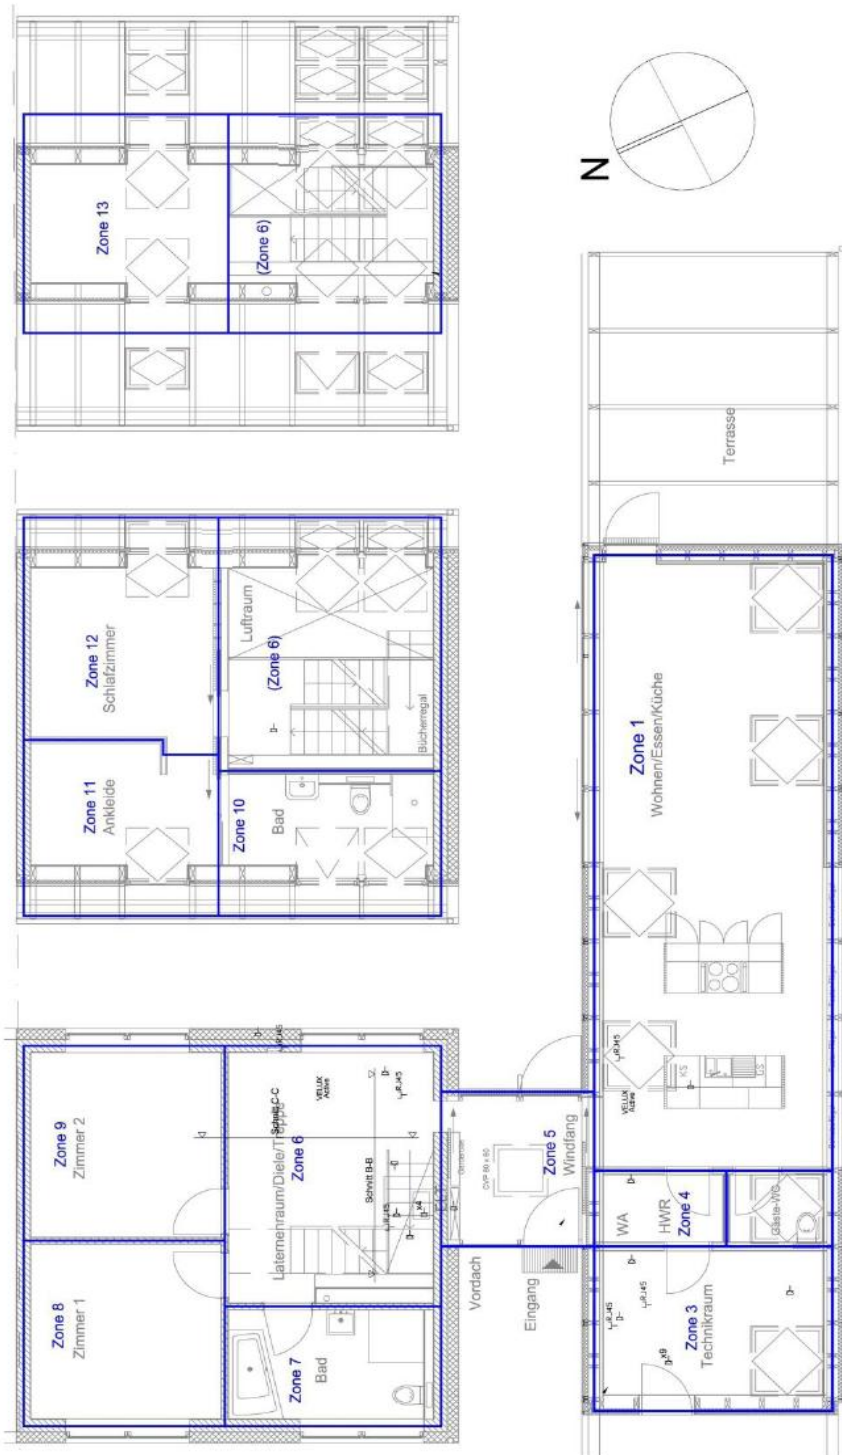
Grundrisse und Zoneneinteilung, nicht maßstabsgetreu (Quelle Velux)
